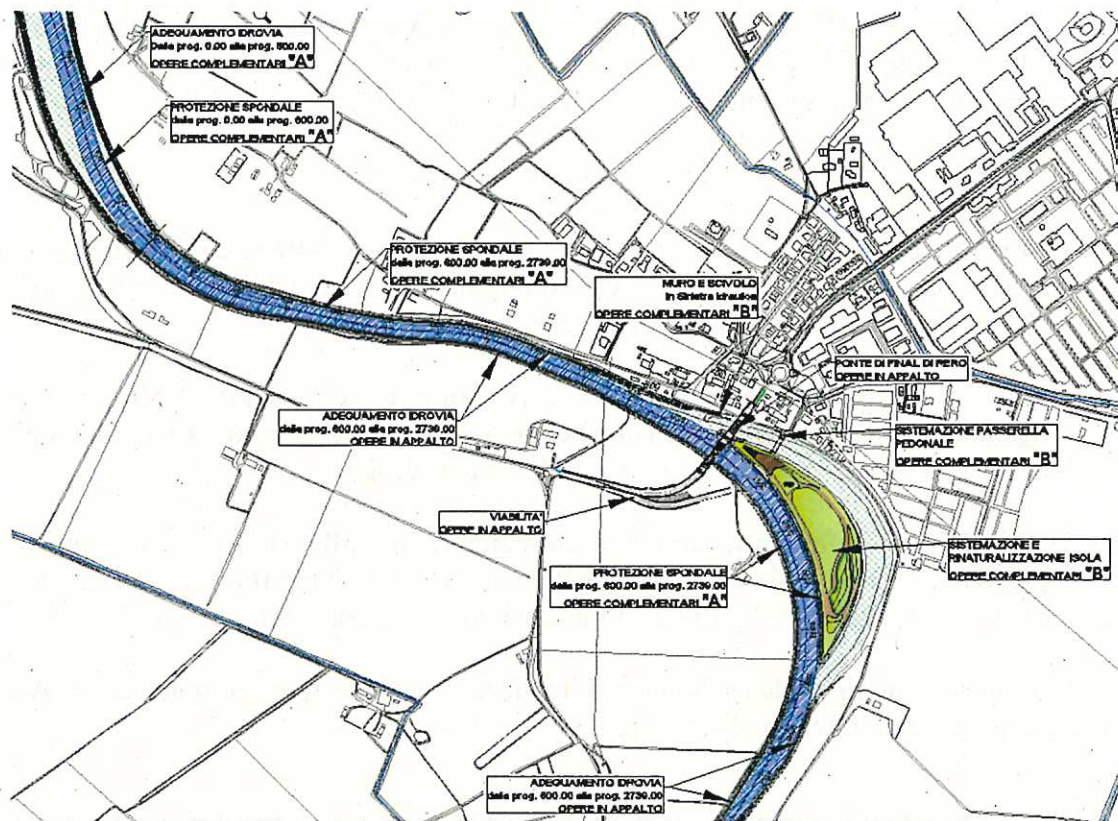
Rappresentazione planimetrica dell'area di intervento con indicazione delle parti d'opera appartenenti ai vari stralci di lavoro previsti
